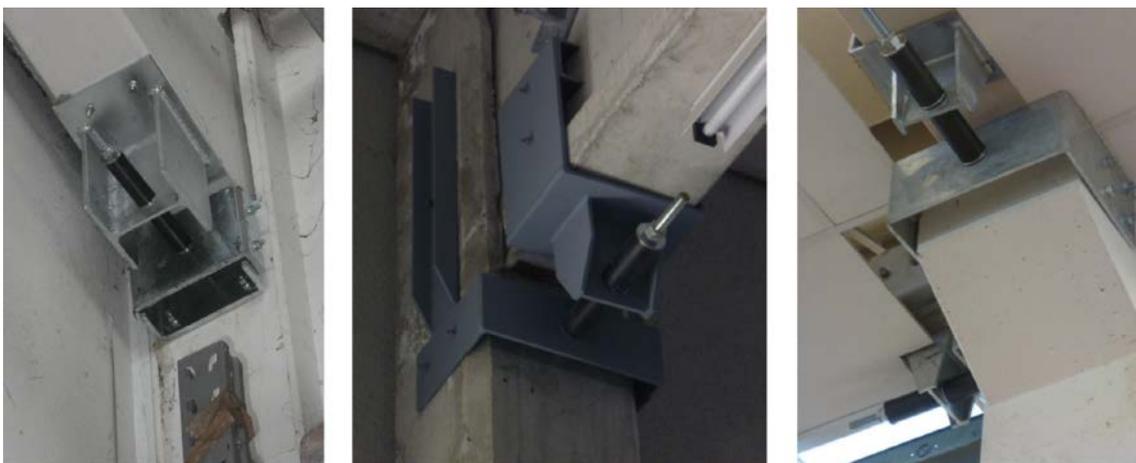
Applicazione dei dispositivi in corrispondenza del nodo trave-pilastro
